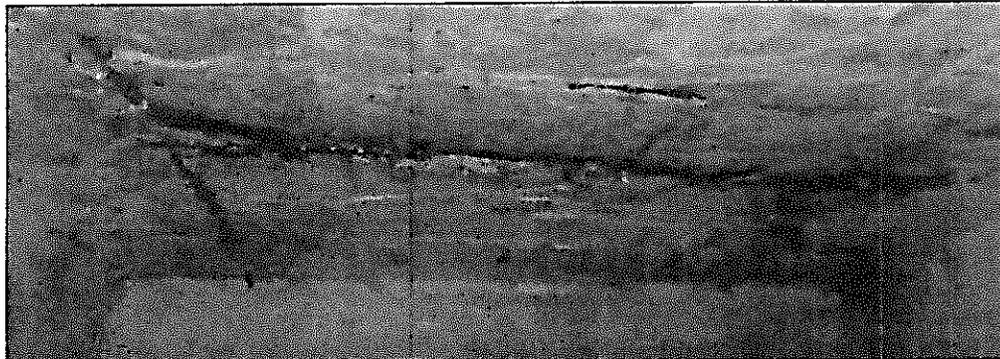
Exposición del acero de refuerzo en la losa de cubierta zona 2.
